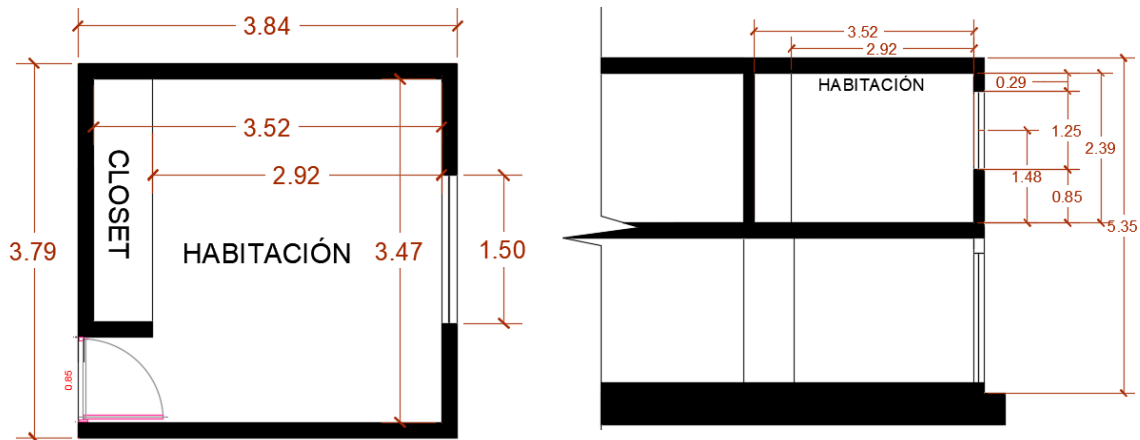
Planta y corte arquitectónicos de la habitación de estudio. Fuente: propia del autor.
